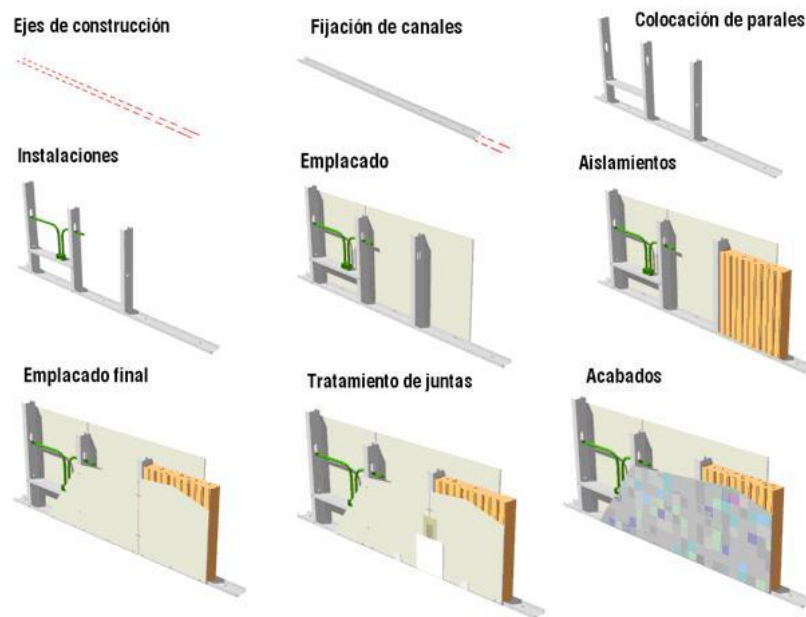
Pasos para instalar un muro hecho en drywall Fuente: (Alberto Domínguez Echeverri, 2007)
